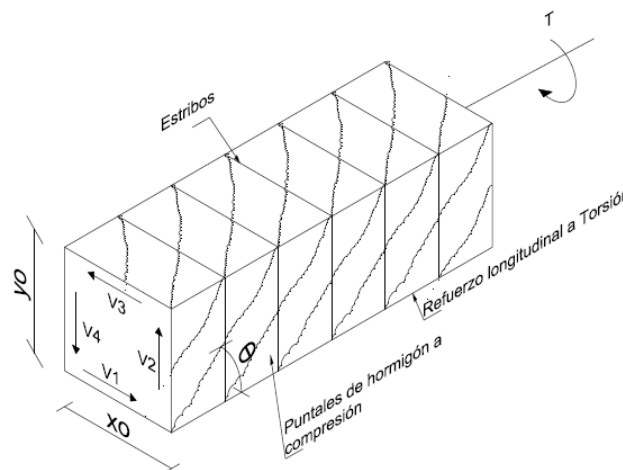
4 Sección confinada por los estribos de refuerzo a torsión.
